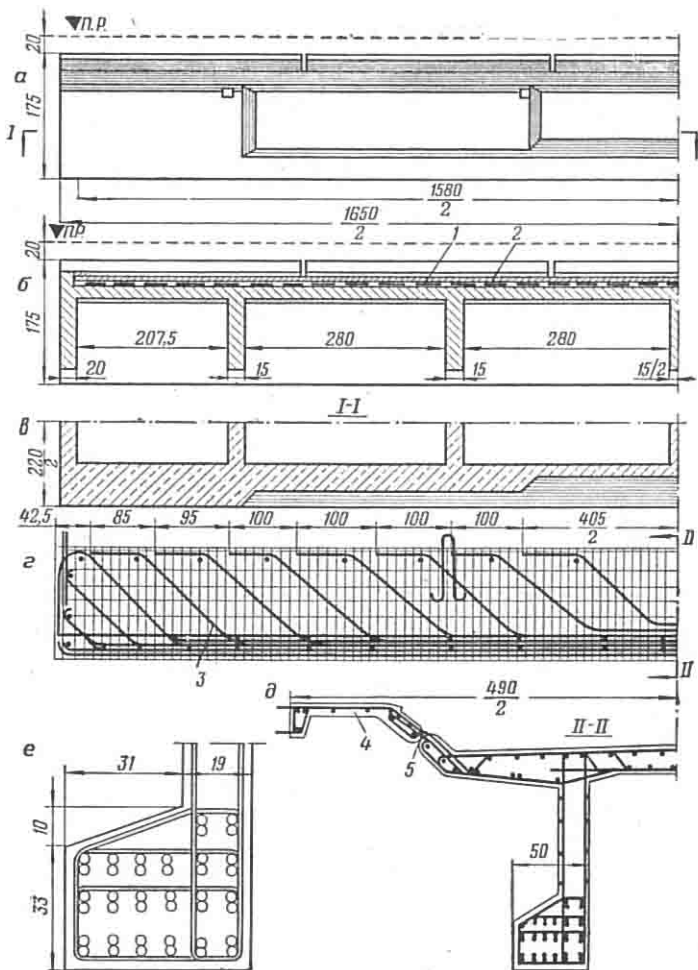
Ребристое цельноперевозимое железобетонное пролетное строение:
